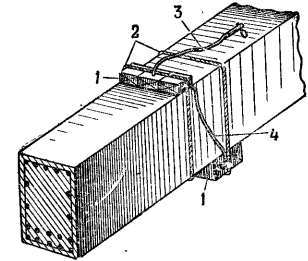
Расчлененное расположение заряда на подрываемой железобетонной балке:
